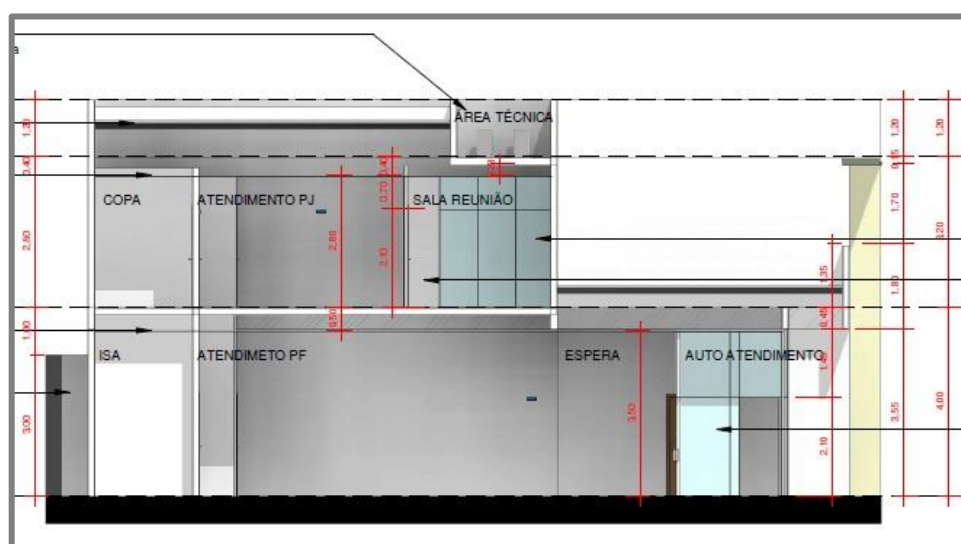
Detalhe da laje técnica para instalação das máquinas de ar condicionado – Projeto Executivo – Prancha EXEC 04.
